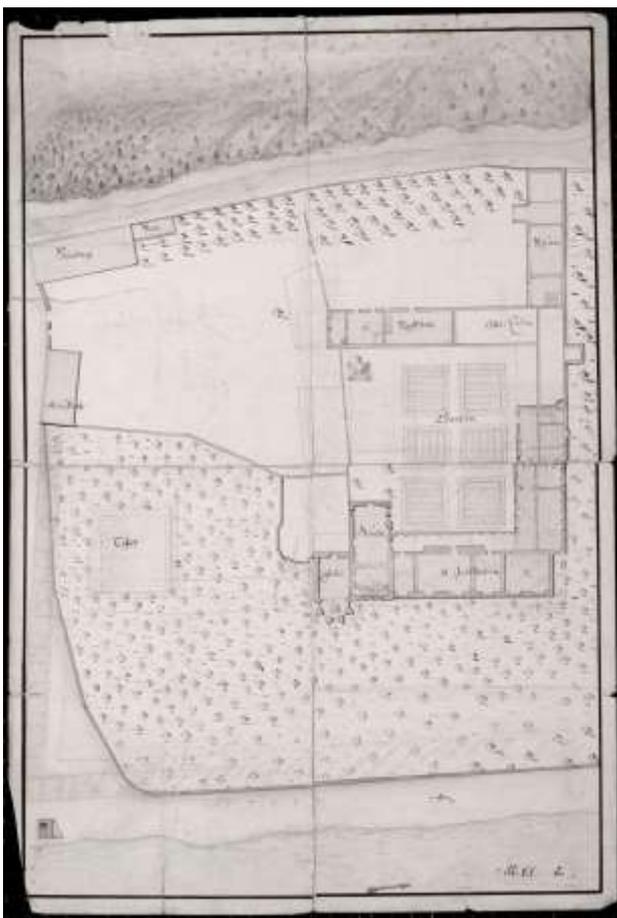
Lageplan des Kloostervorwerks „Zum heiligen Kreuz“, neu um 1720-30
